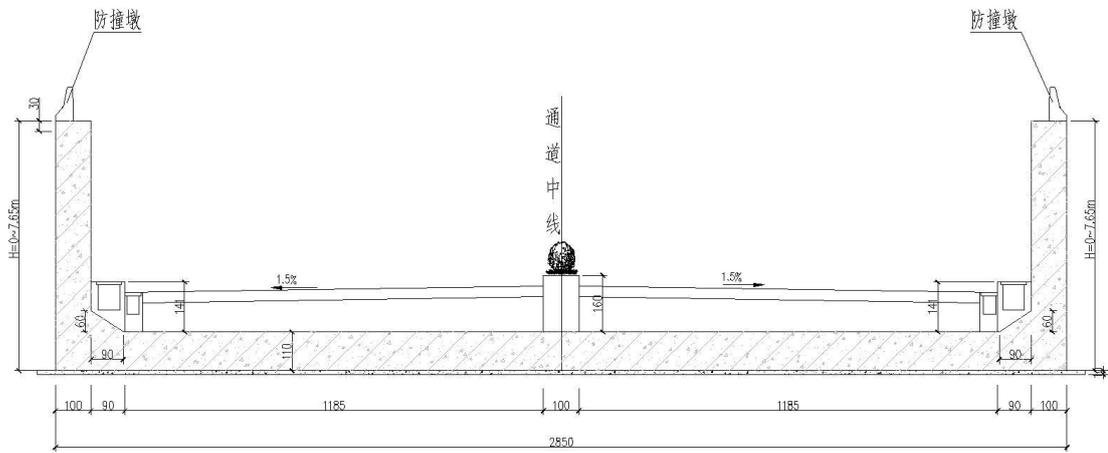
明挖 U 型槽通道断面布置图（尺寸单位：cm）
